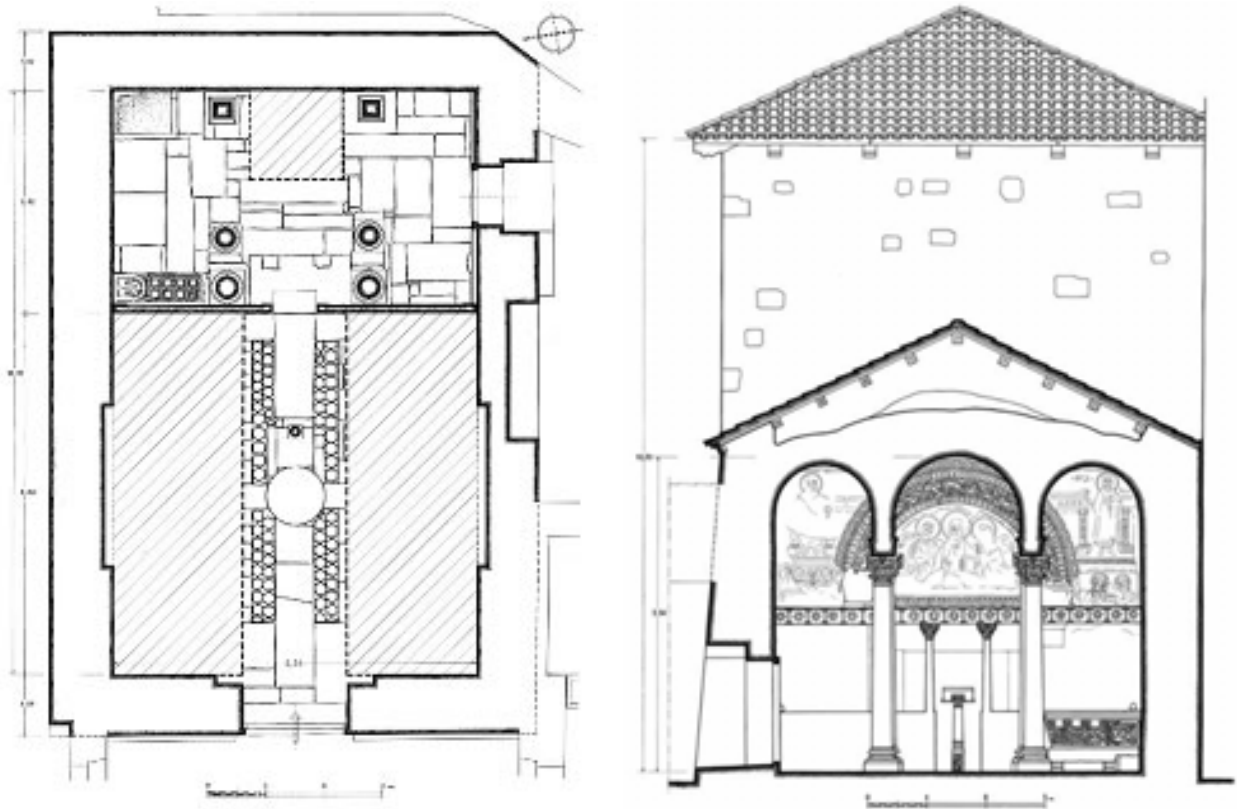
CIVIDALE: TEMPIETTO, A: PIANTA; B: SEZIONE (DA I LONGOBARDI 1990)
